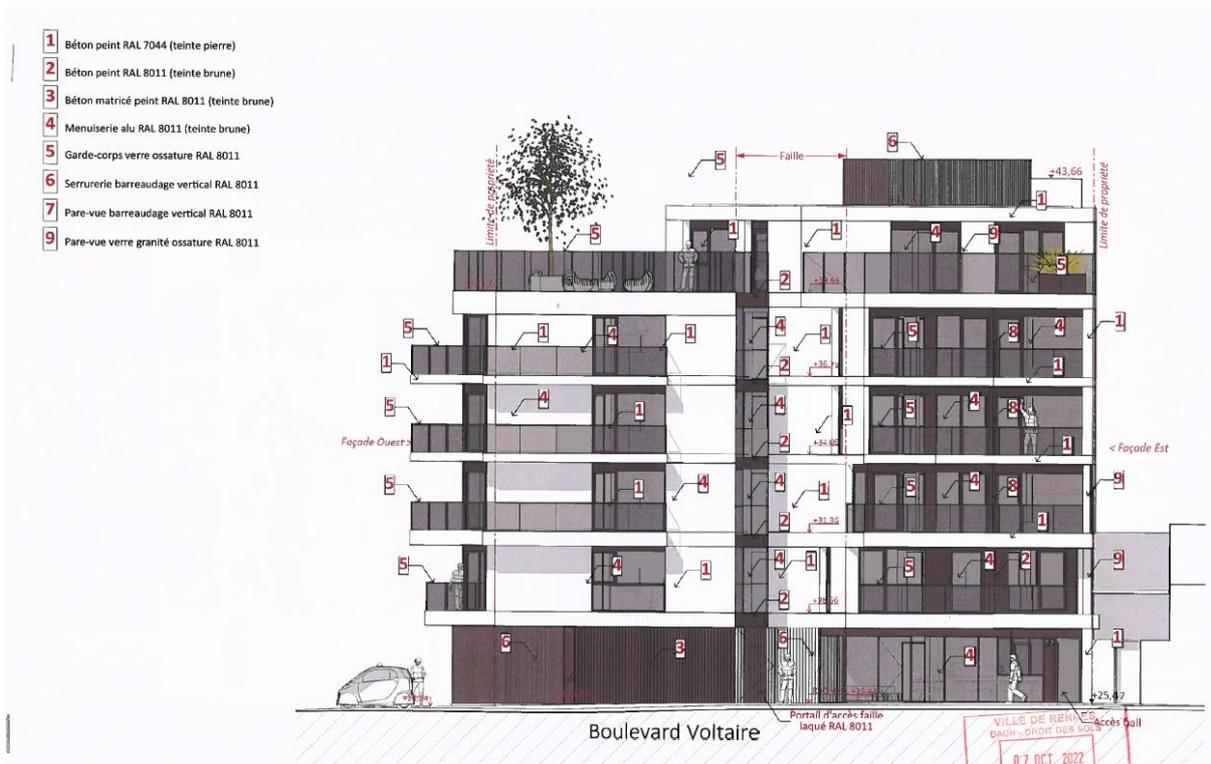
Façade Sud au 14/06/2022 - © ALTA Architecture
